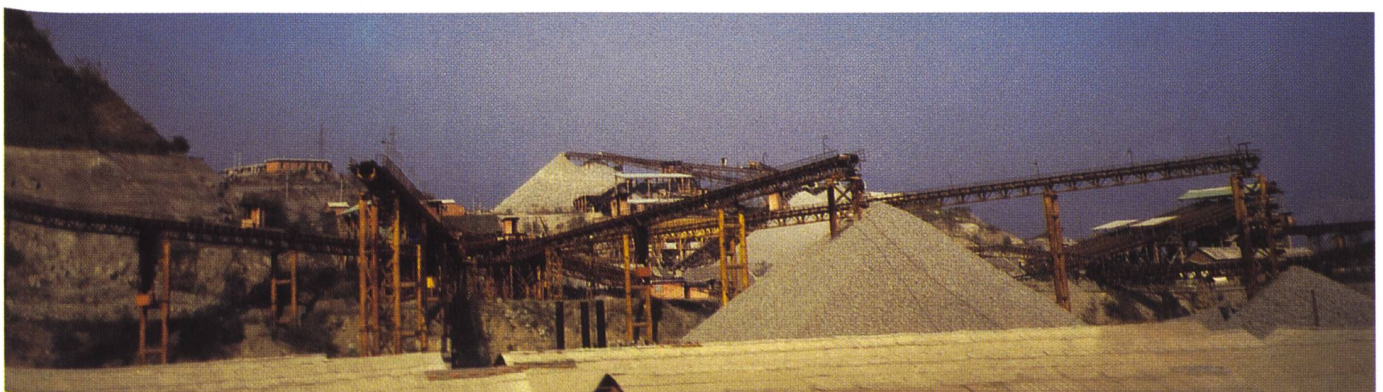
Aufbereitungsanlage für Betonzuschlagstoffe im Baustellenbereich.
